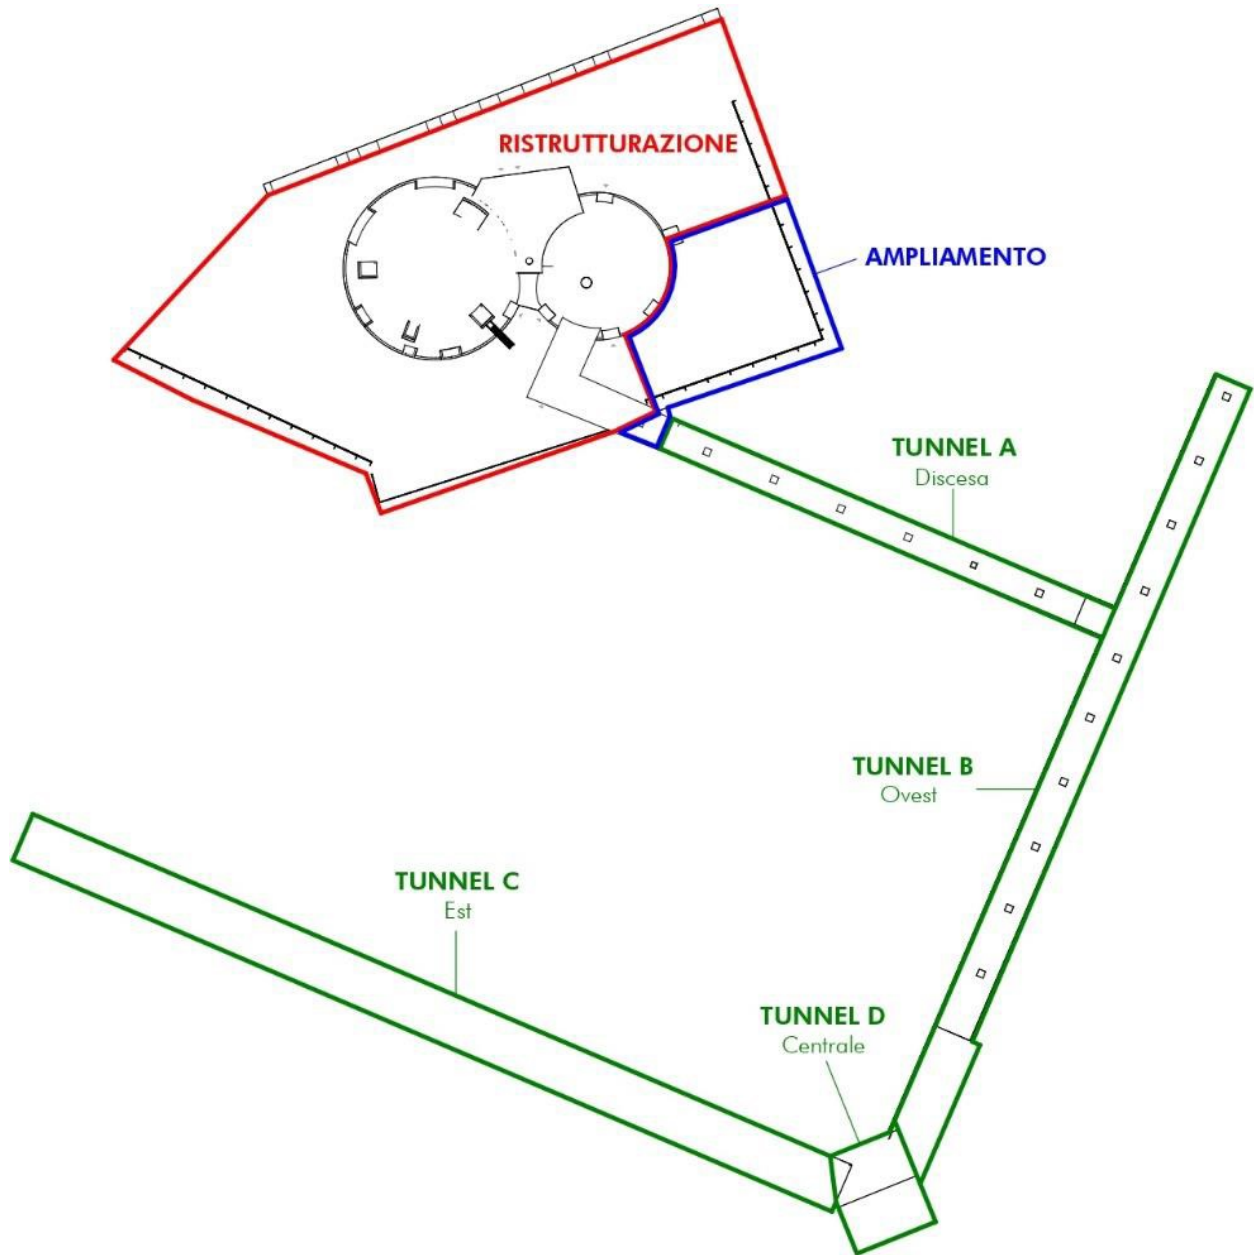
Schema interventi previsti in progetto (fonte Progetto - AIACE)
